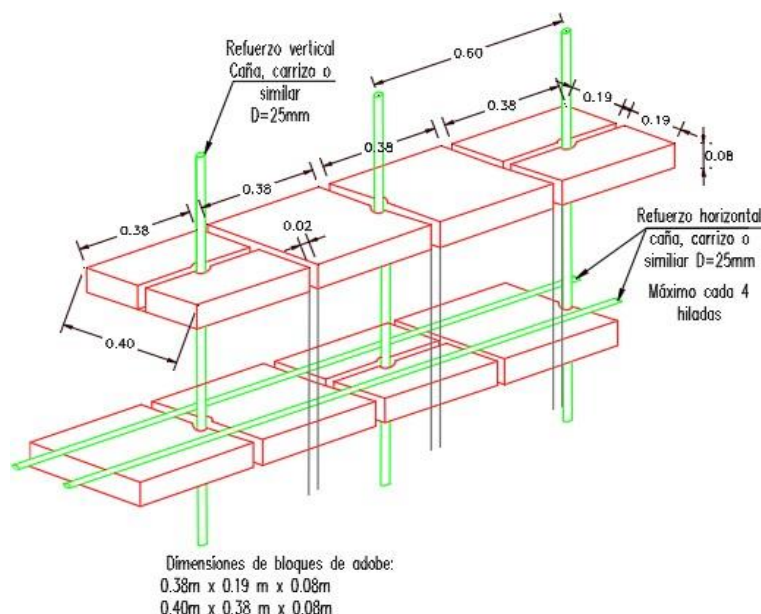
Refuerzos horizontales y verticales de caña o similares (E.80 Adobe)
